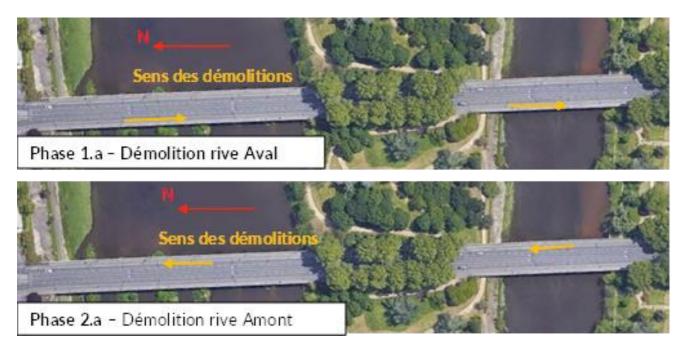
sens des démolitions des dalles béton sur les ouvrages OA3 et OA4 (Pont Sanitas)
